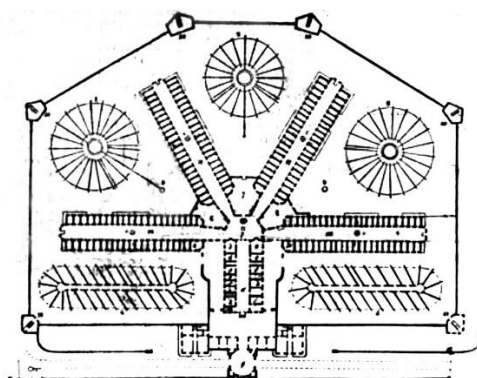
Prisão Pentonville, em Inglaterra (1842): Planta
